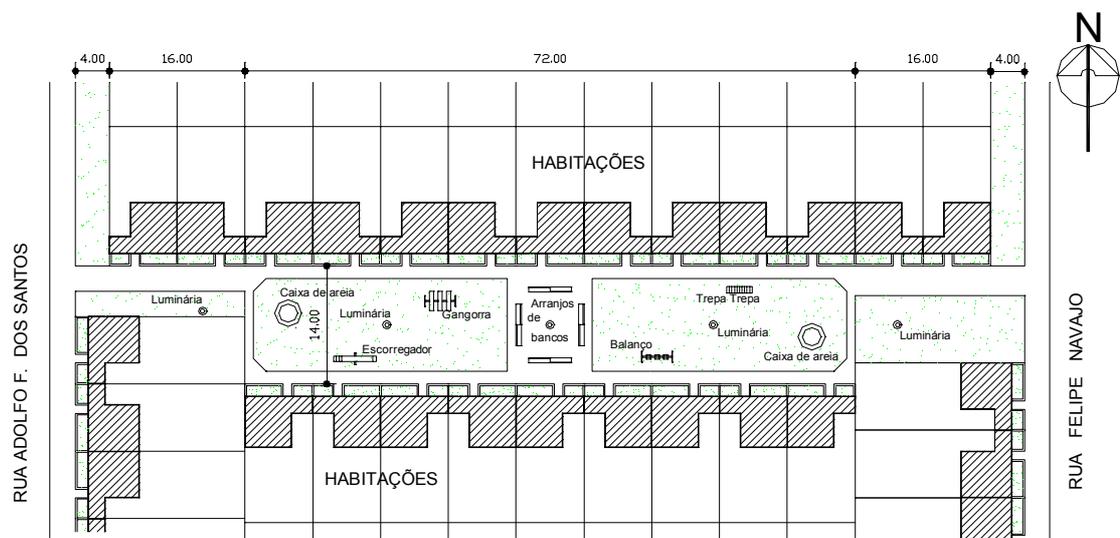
Planta Original do Espaço Aberto Comum 7 do CHST
